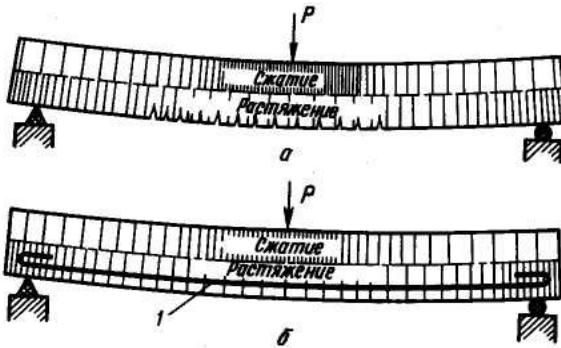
Неармированная бетонная (а) и армированная железобетонная (б) балки: 1 – арматура
